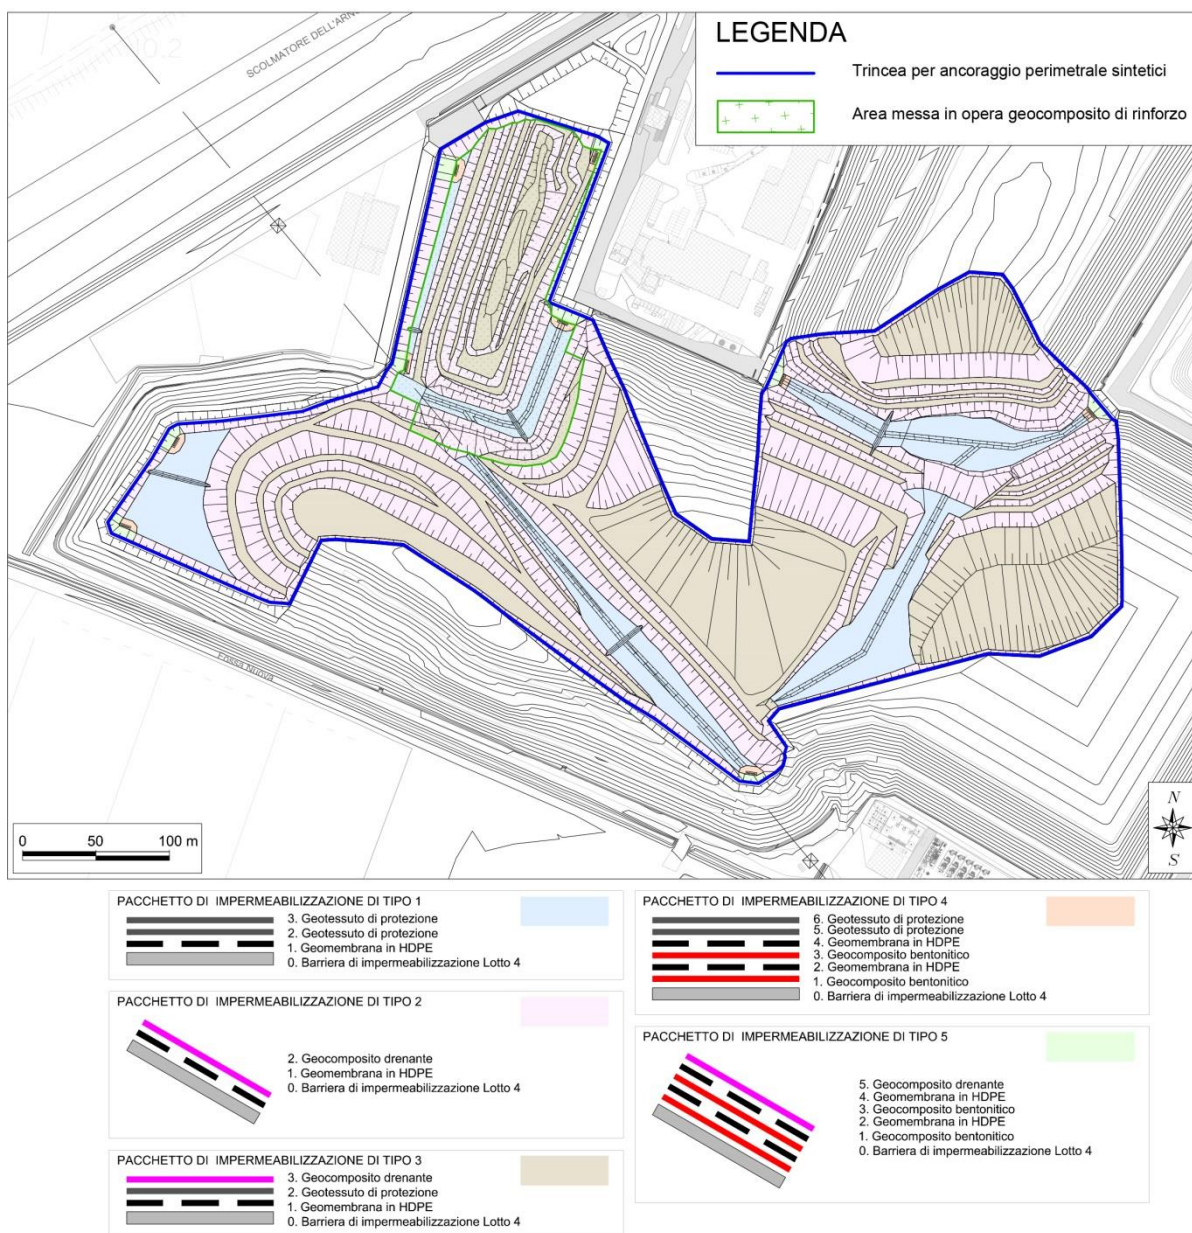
51 – Sistema barriera impermeabile del fondo e delle pareti LOTTO 4
